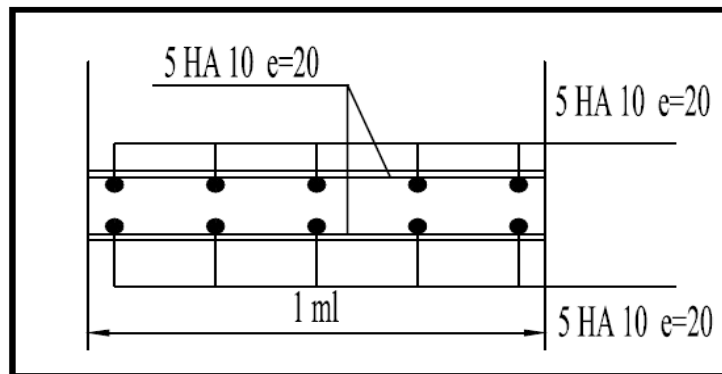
Schéma de ferrailage de la dalle Pleine.
